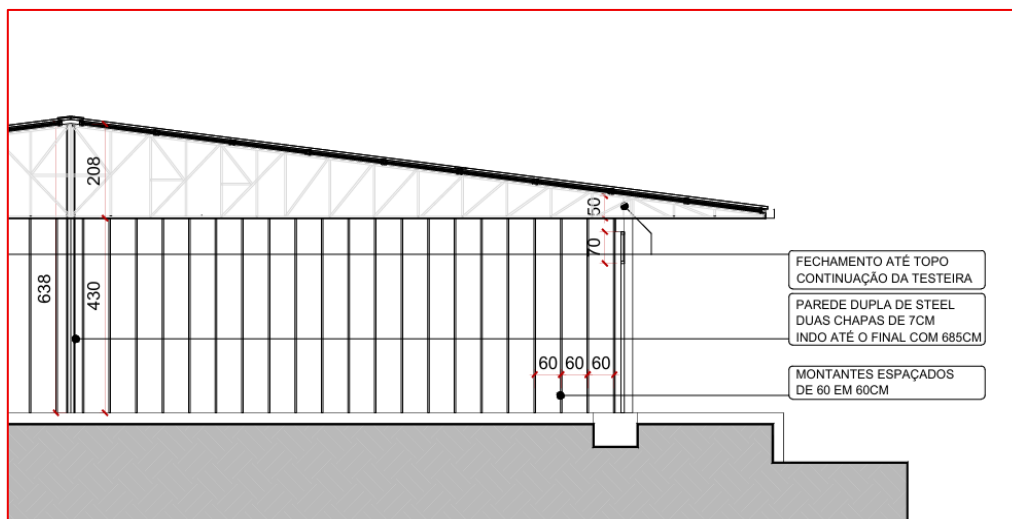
Corte esquemático elevação da parede em Steel Frame. Fonte: Projeto.
